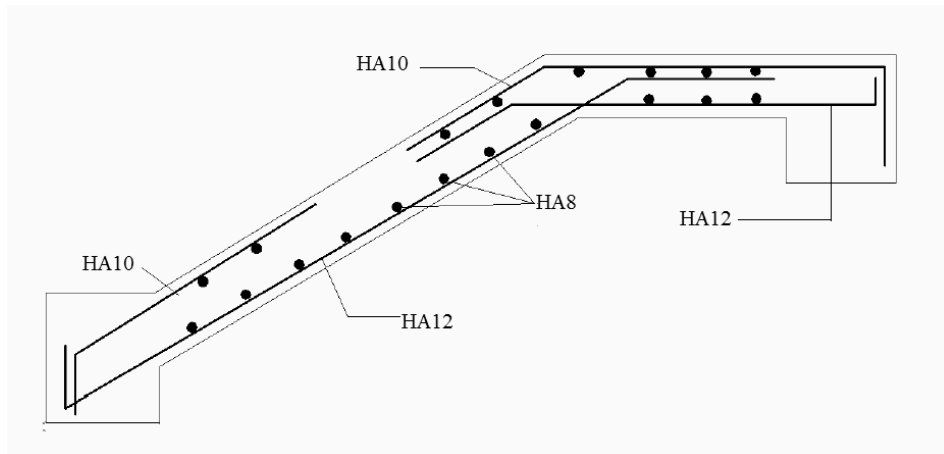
Schéma de ferrailage de l’escalier type2 (volée1)
